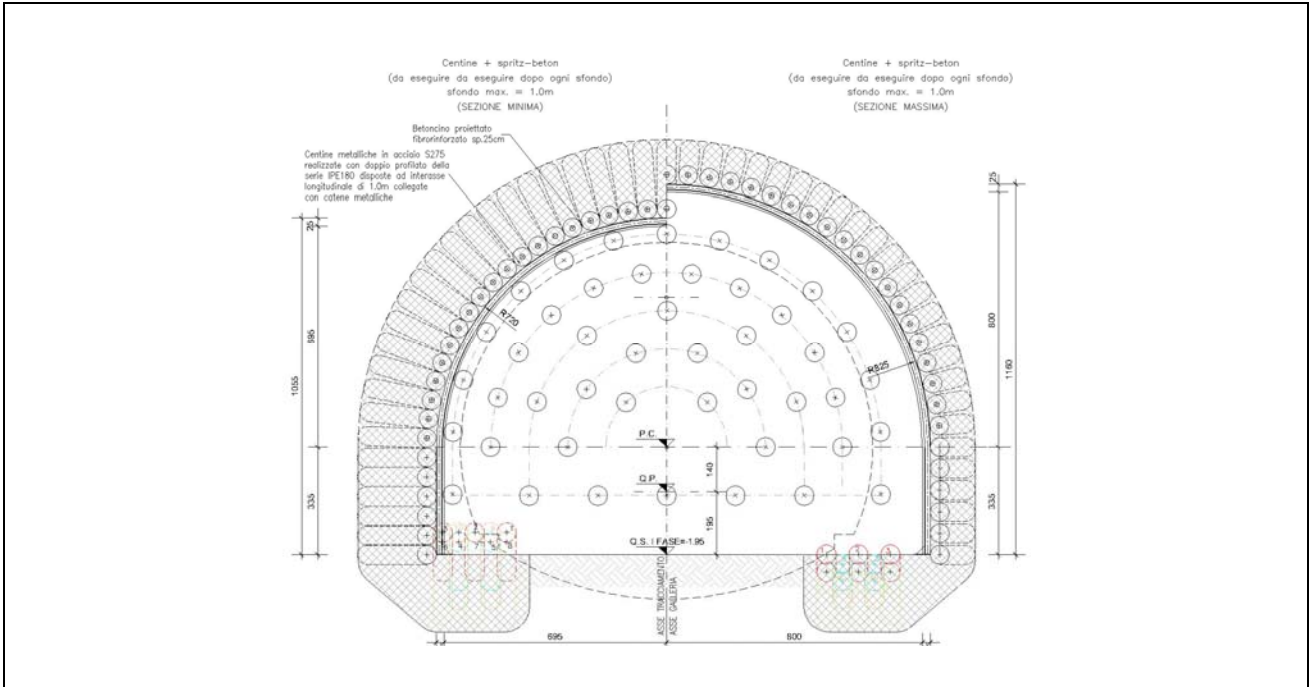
Sezione di scavo tipo GD-C3 Concio d'attacco - Sezione trasversale
